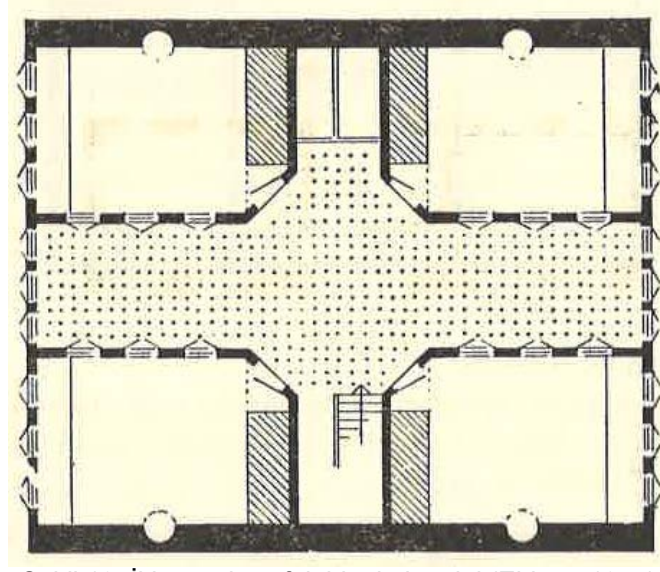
Sofasız plan tipi (Eldem, 1954)
